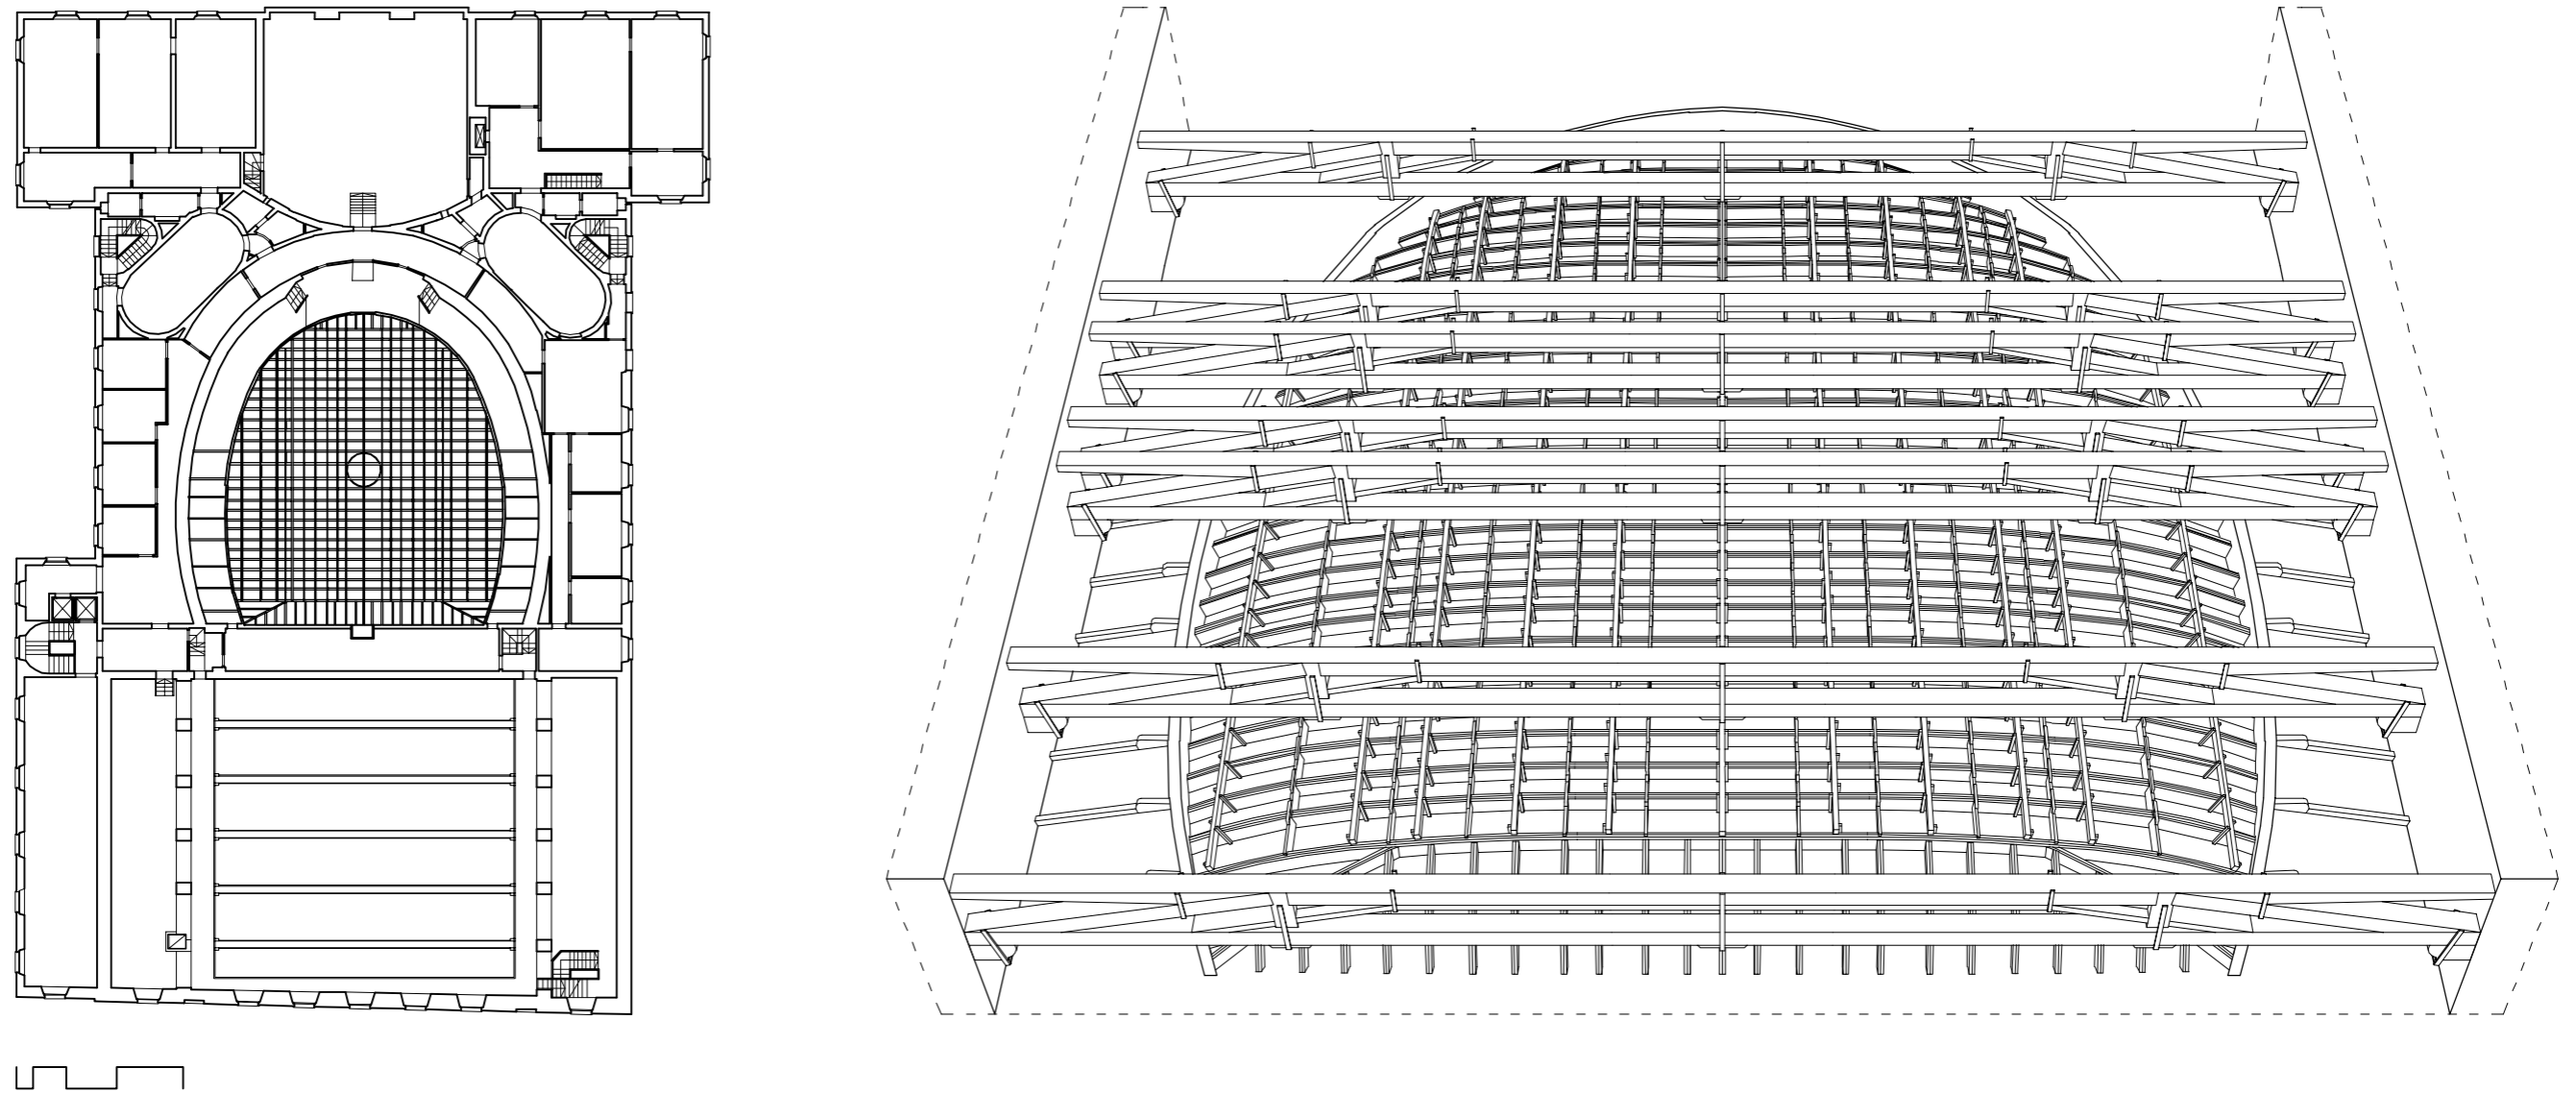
Teatro Comunale “Luciano Pavarotti” di Modena. Pianta del piano sottotetto (ridisegno); rappresentazione prospettica del sistema di copertura della sala.
